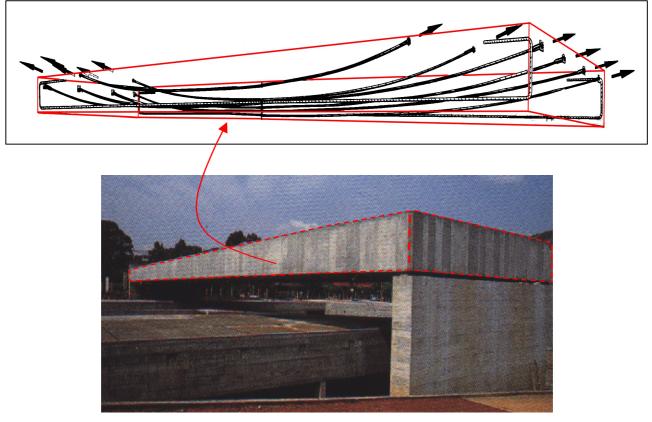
Posicionamento de bainhas em uma laje de concreto protendida
